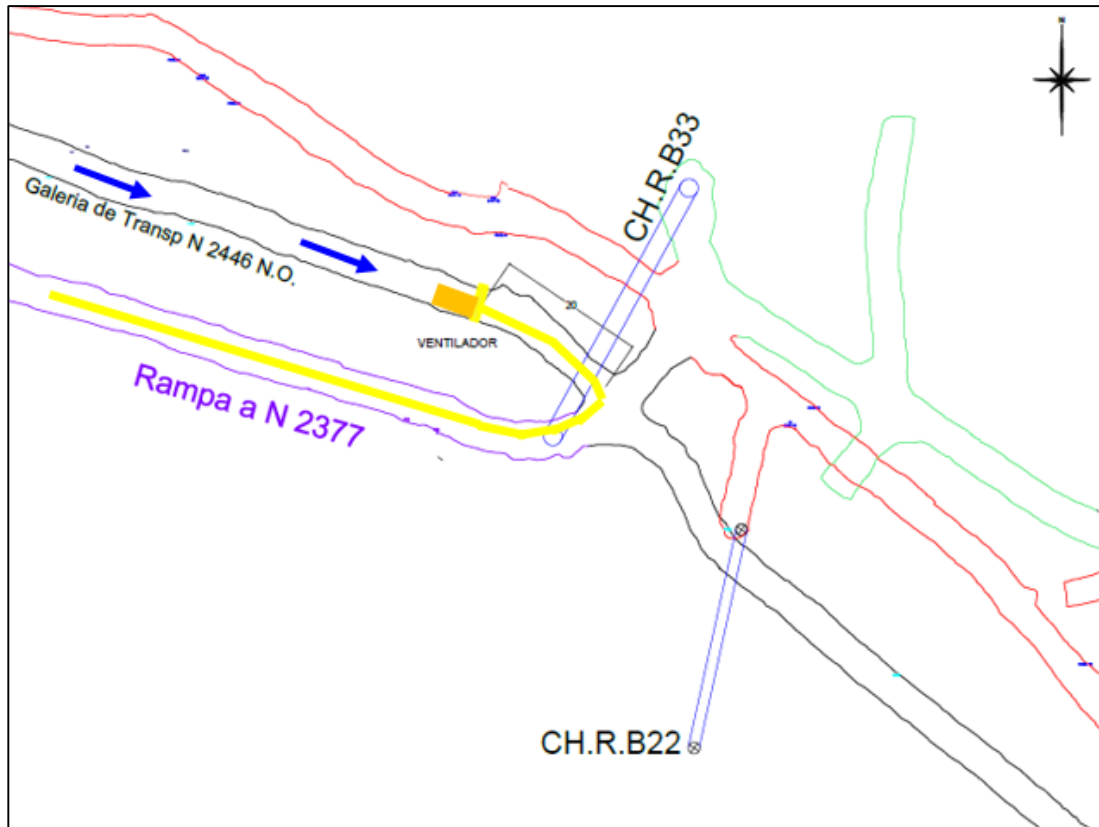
Vista en planta de la ubicación recomendada del ventilador.
